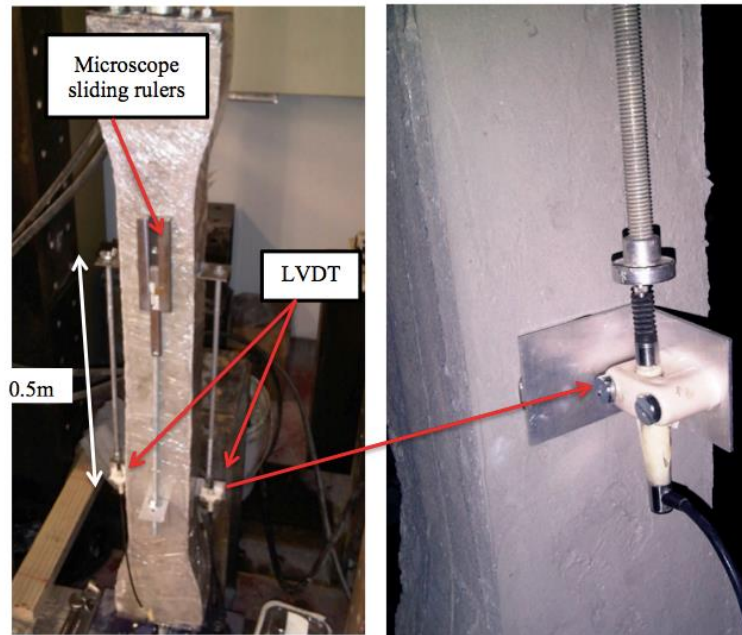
Pormenor do sistema de medição de deformações utilizado por De Sousa (2011)
